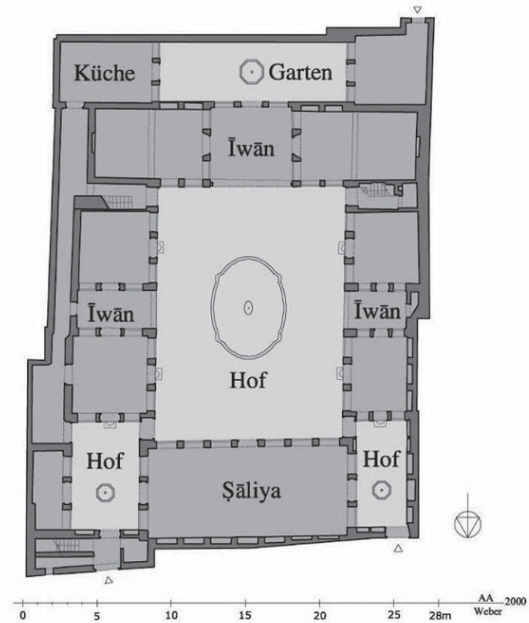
Bayt Hasan al-Quwatli - Grundriss EG
